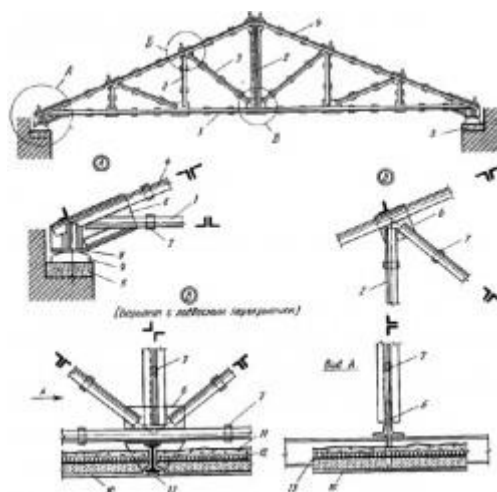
Металл о деревянная ферма с подвесным чердачным перекрытием: 1 — нижний пояс фермы, 2 — стальная стойка фермы, 3 — раскос, 4 — верхний пояс фермы, 5 — накладка стыка верхнего пояса, 6 — прогон под наслонные стропильные ноги, 7 — стропильные ноги через 1,2... 1,5 м, 8 - кровля по обрешетке, 9 - прогон подвесного покрытия, 10 — балки с черепными брусками, 11 — бобышка, 12 — накладка стыка нижнего пояса, 13 — уголок, 14 — шлак, 15 — минеральный войлок, 16 — пароизоляция, 17 - накат, 18 — болты, 19 — сталь полосовая, 20— черепной брусок прогона
